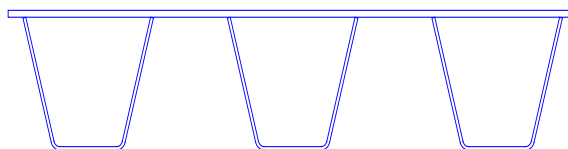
Ортотропная конструкция с закрытыми ребрами. Без нагрузки
